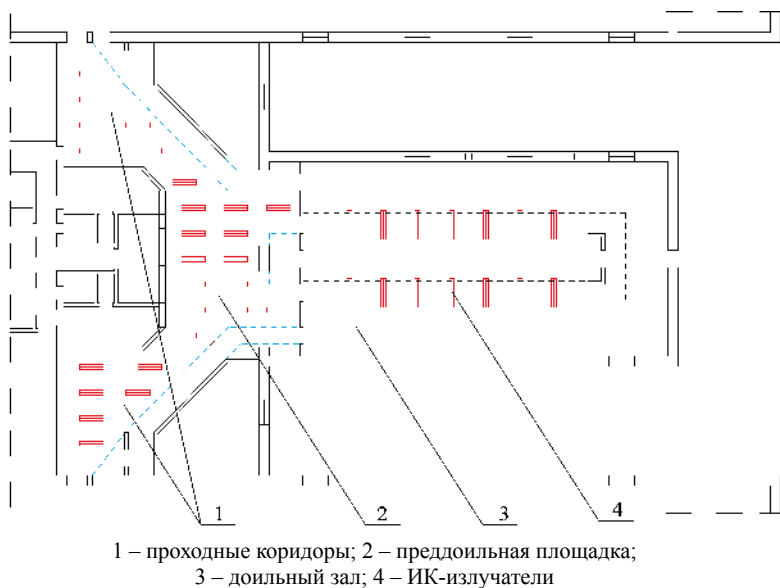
Расстановка ИК-излучателей в доильно-молочном блоке
